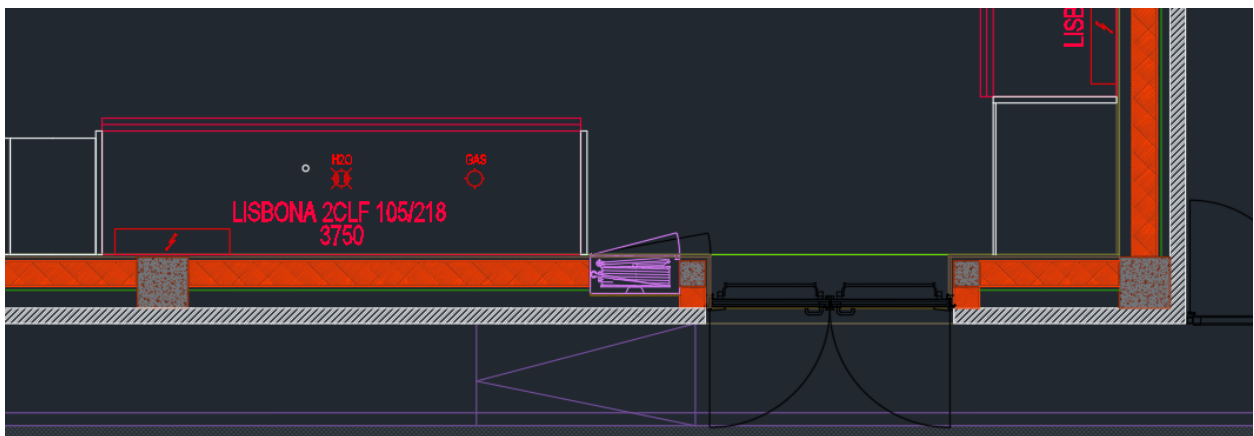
Detalhe dos pilares na planta arquitetônica.
